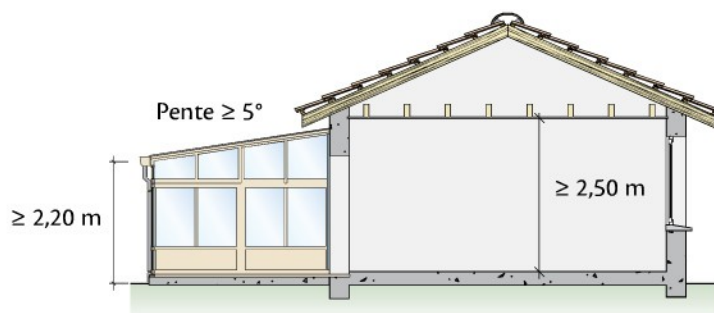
Le faîtage s'appuie sur le mur de la maison de plain-pied sous la gouttière de la toiture
